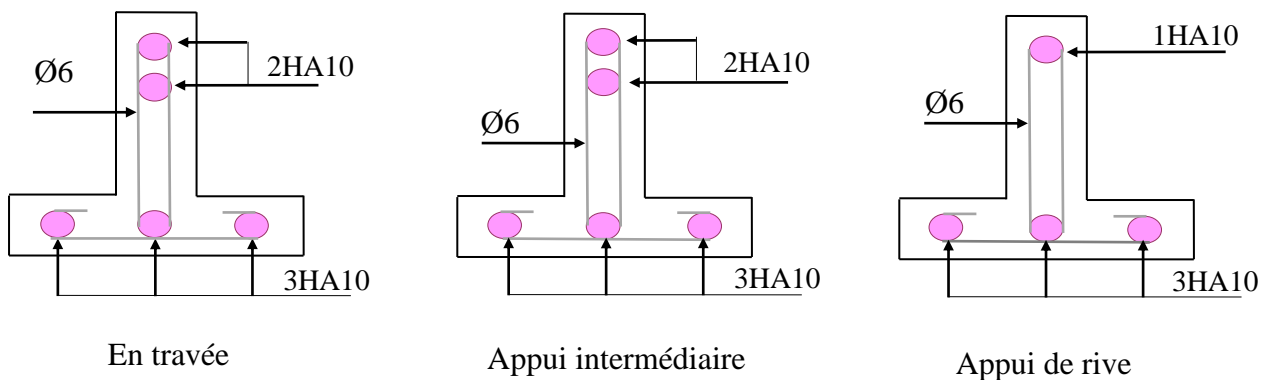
Schéma de Ferrailage des poutrelles plancher terrasse (Type2).
